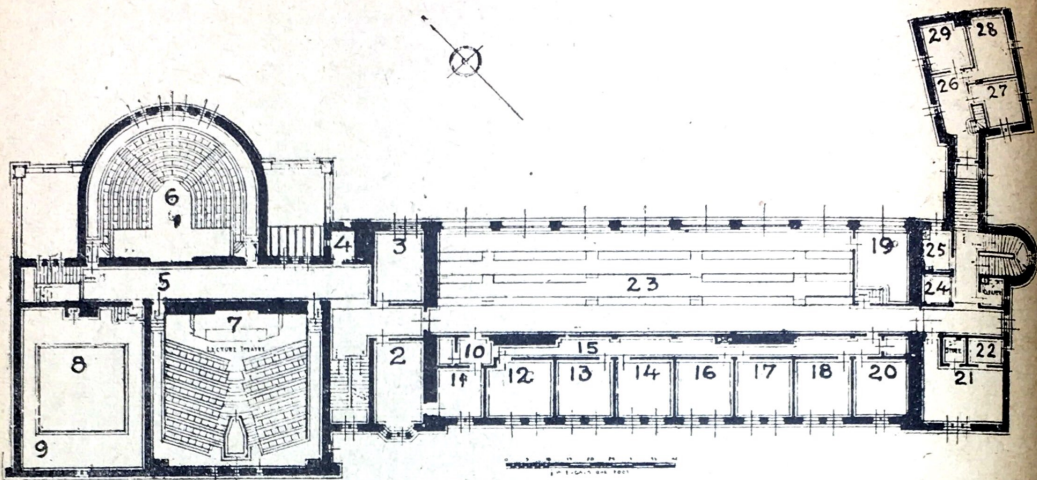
PLANTA DEL SEGUNDO PISO.
